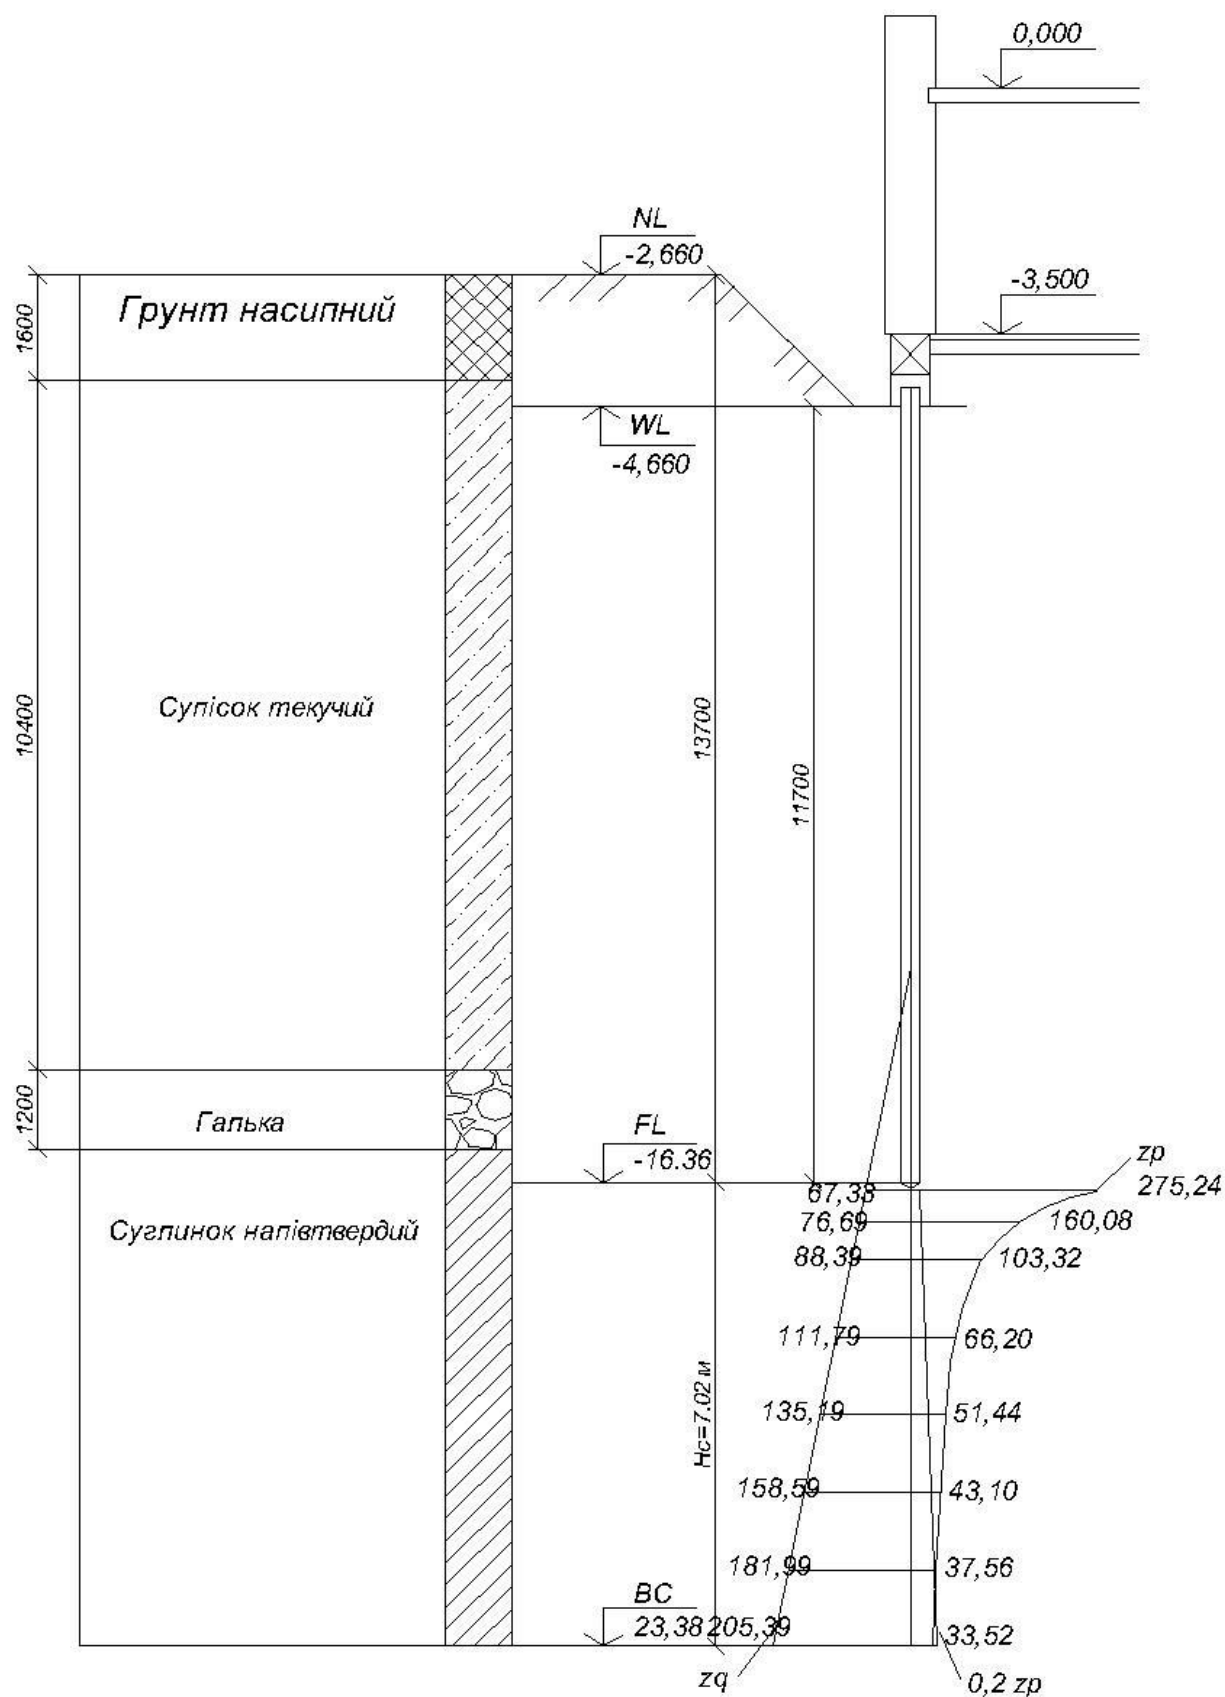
Схема до розрахунку просідання стрічкового пальового фундаменту по осі Б, В на ділянці 14-20
